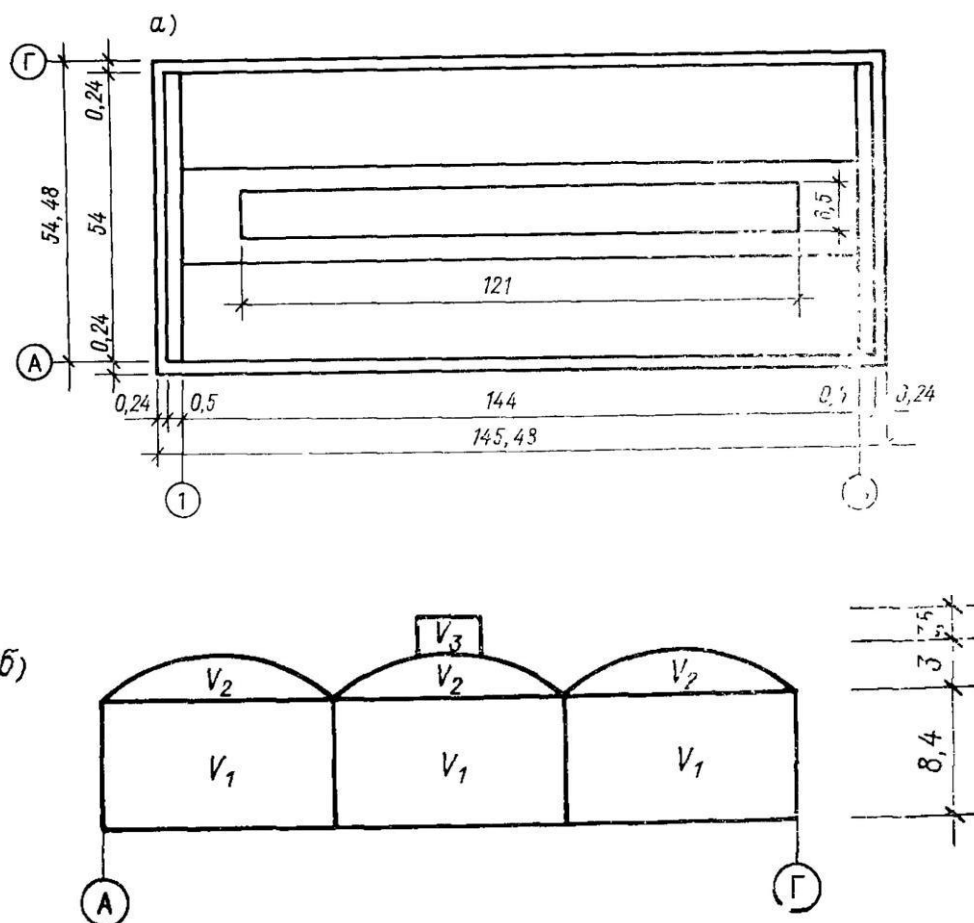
Определение строительного объема промышленного здания а — план; б — схематический разрез
